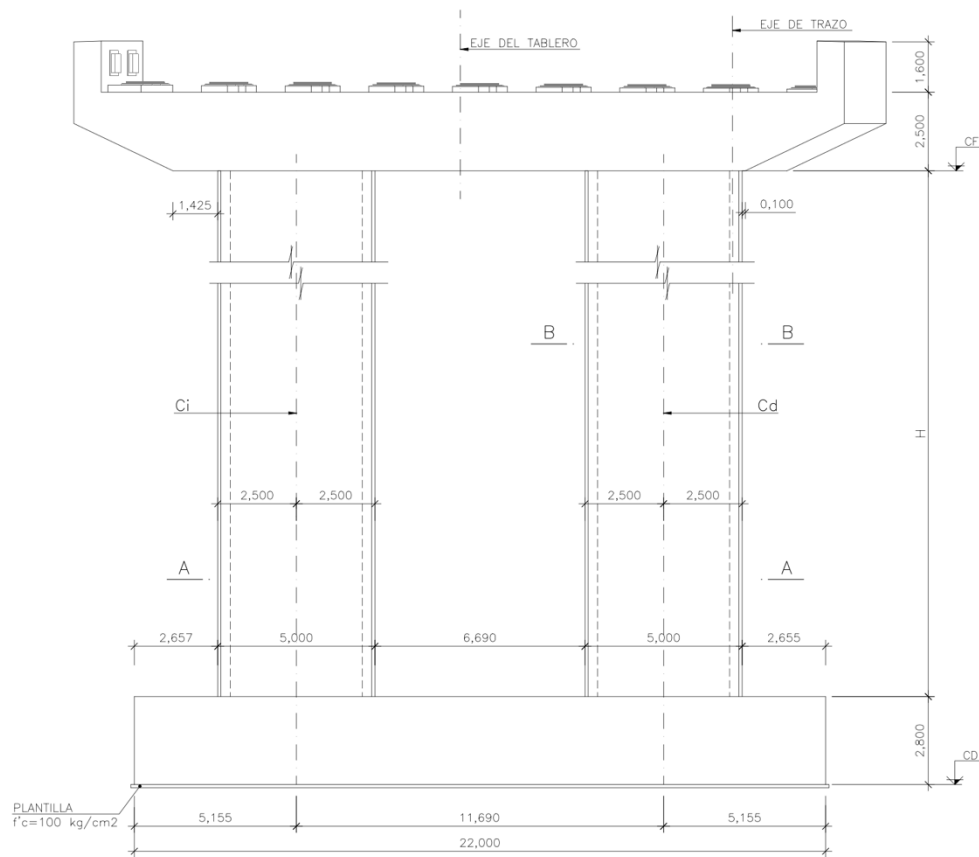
Pila en el apoyo 5 (OHL, 2014).
